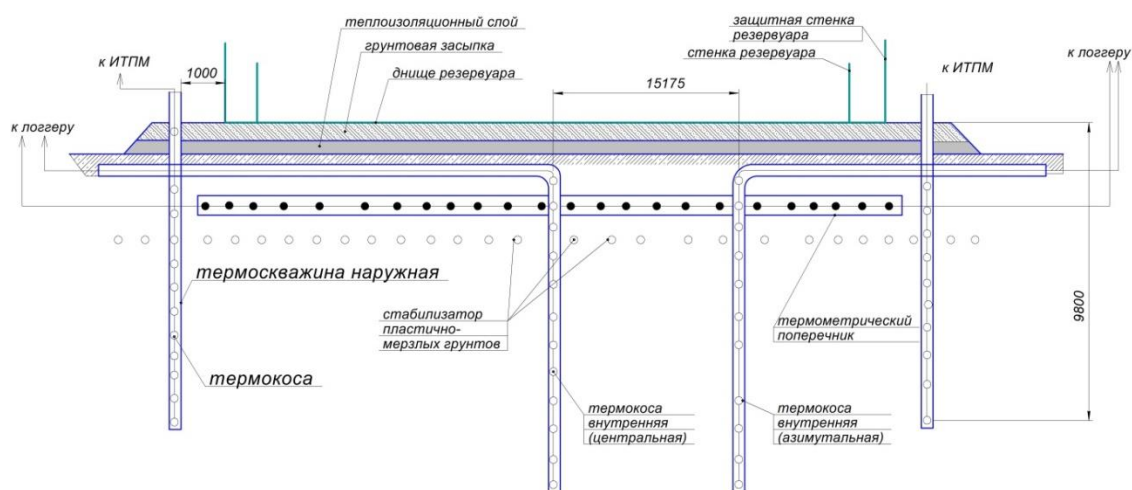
Схема расположения скважин и термокос под резервуаром
